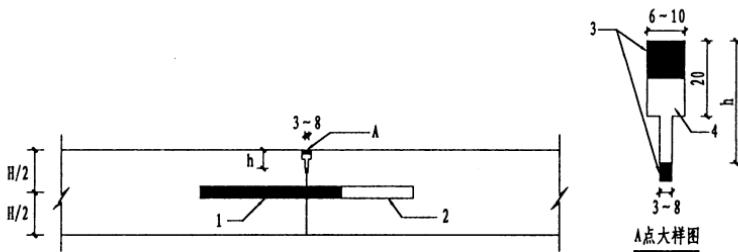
浅槽口构造(尺寸单位:mm)
